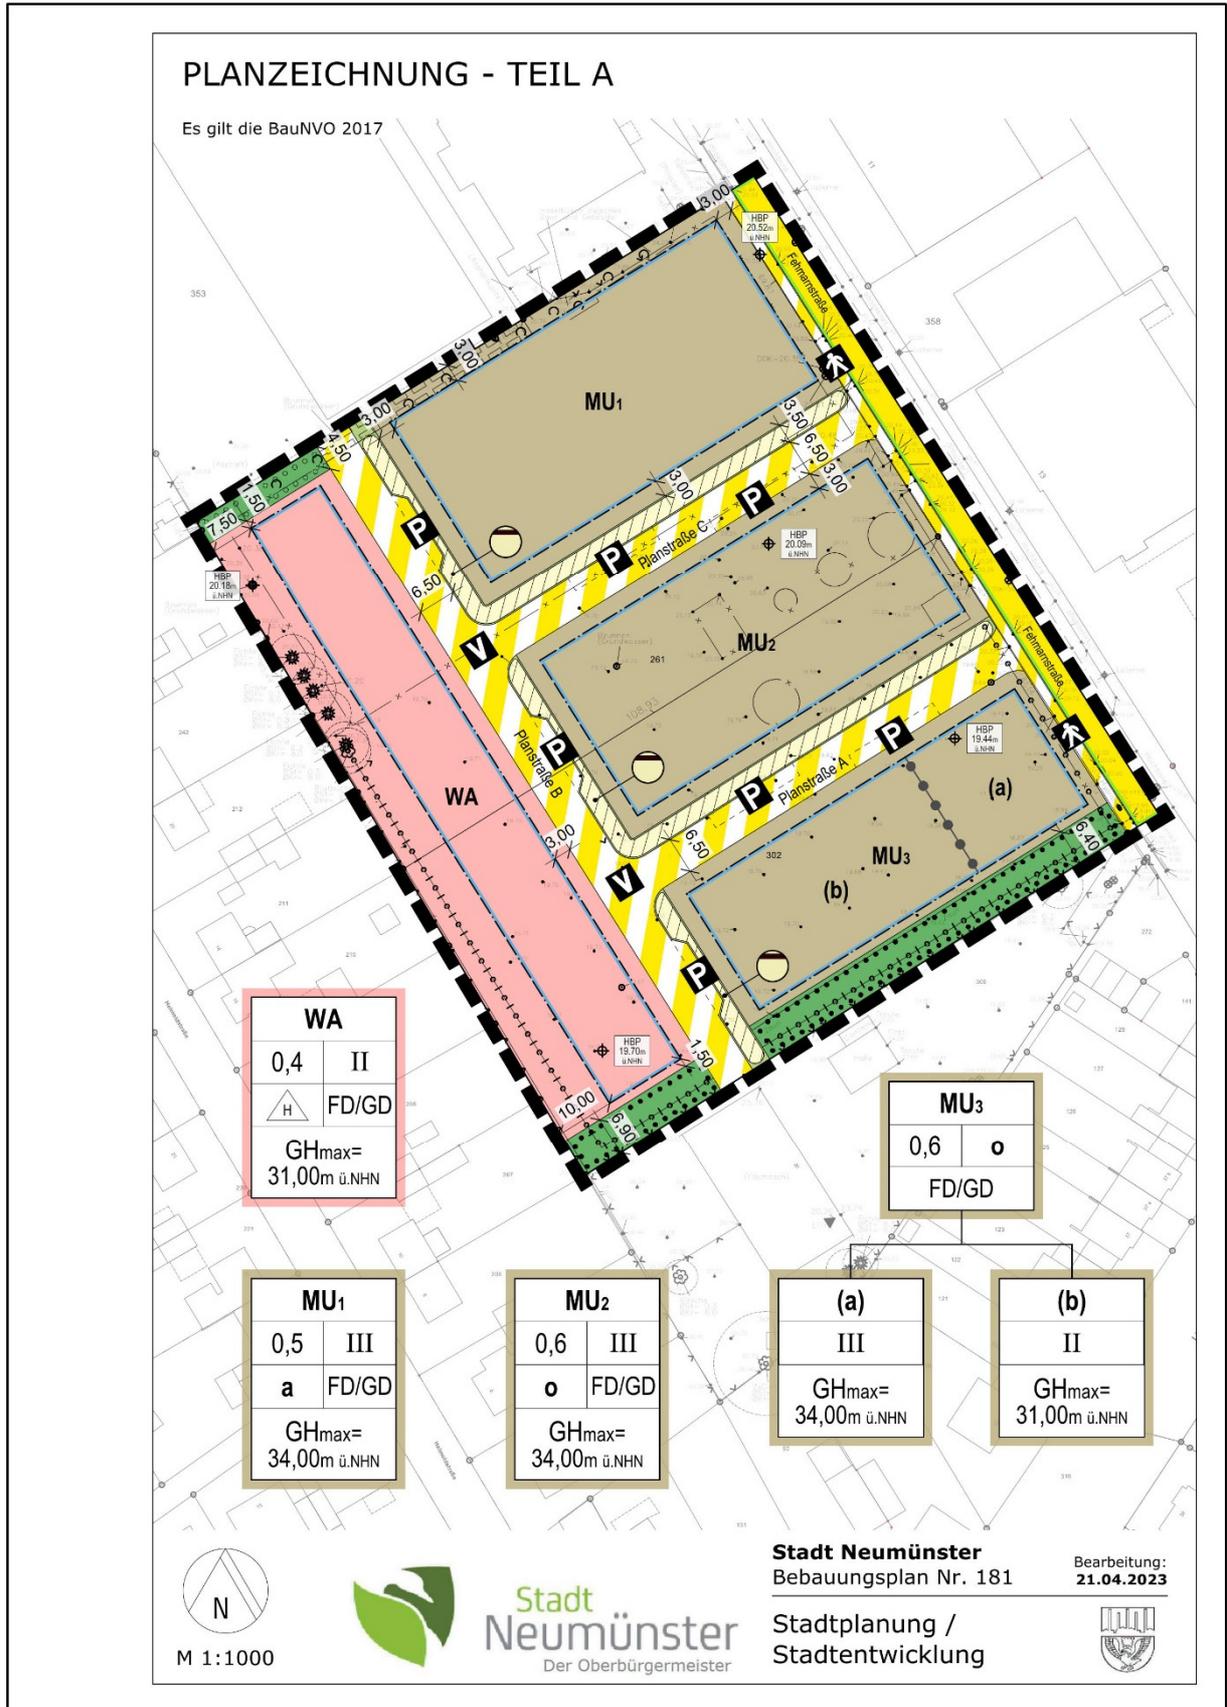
Planzeichnung Teil A, Bebauungsplan Nr. 181 der Stadt Neumünster (Stand 21.04.2023)
